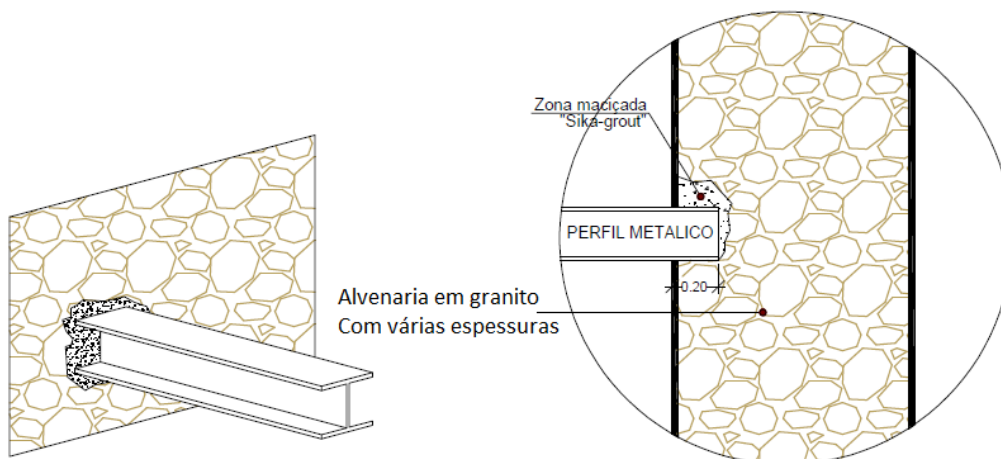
Pormenor da ligação das vigas metálicas às paredes resistentes (corte)
